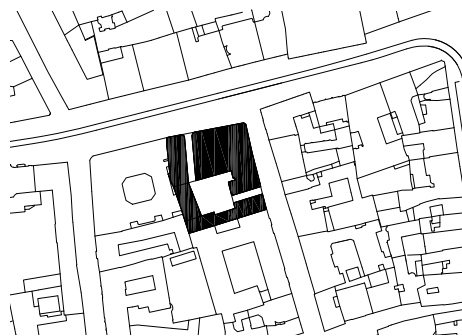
Pasáž paláce Broadway 1:4000.
